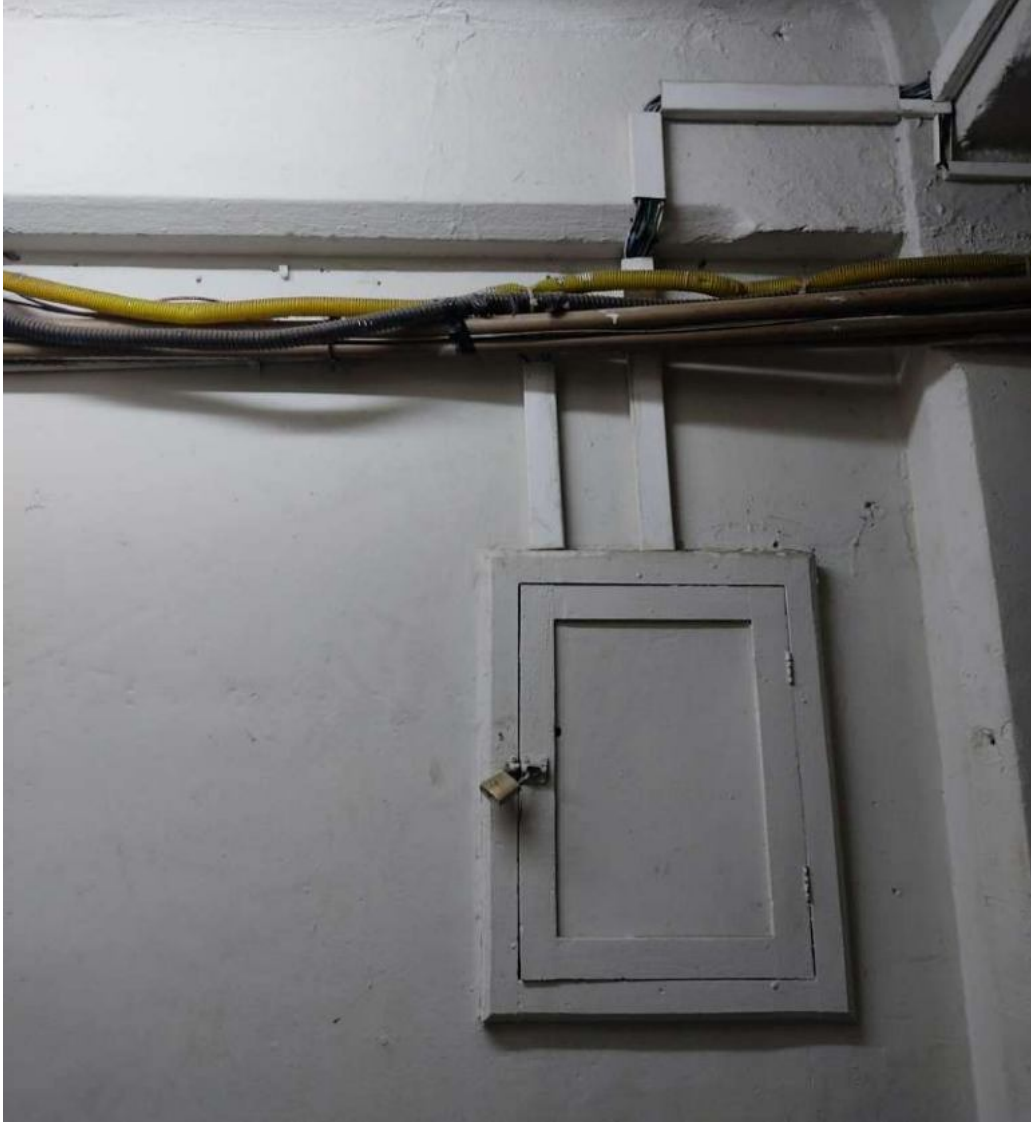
entrada da tubulação elétrica e hidráulica no prédio, no primeiro pavimento.
